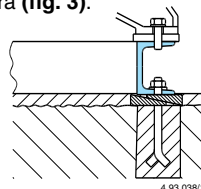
Fondazione per gruppo su piastra di base di profilati saldati.
